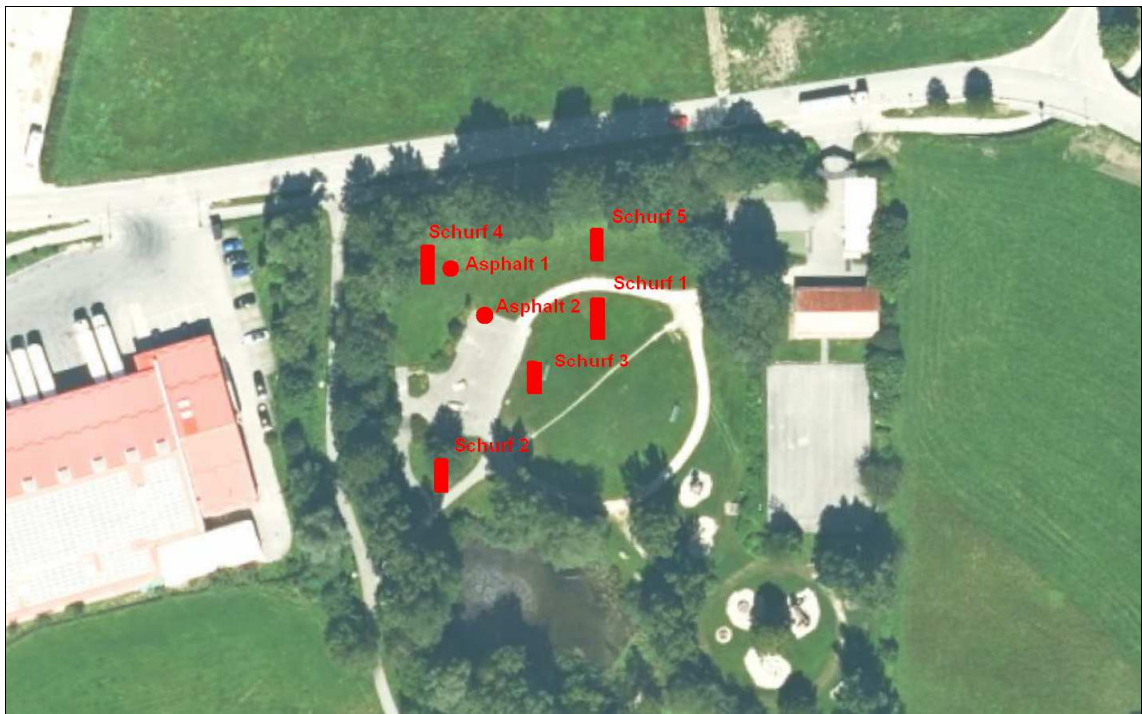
Lageplan Ausschnitt (ohne Maßstab) mit Lage der Baggerschürfe
